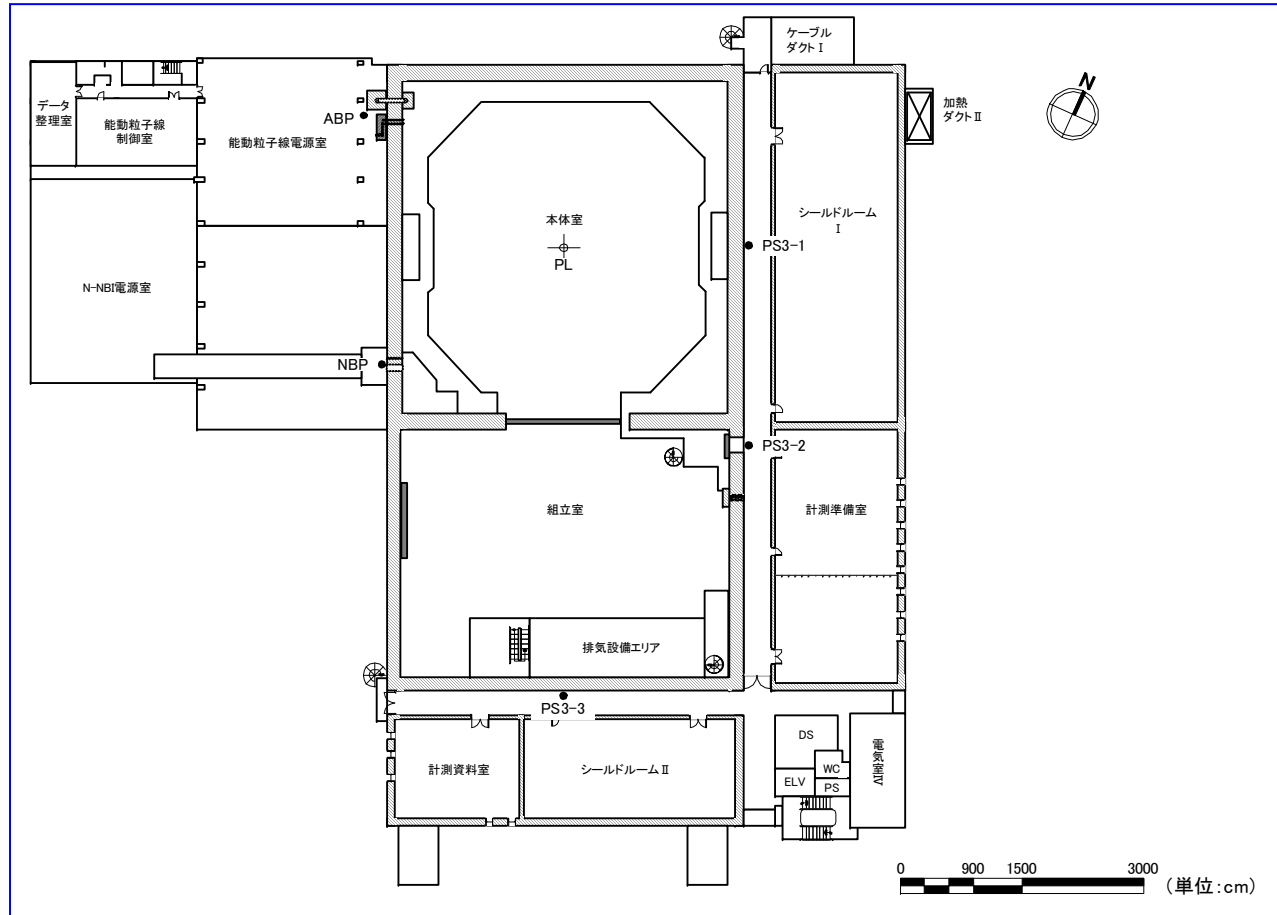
1. 5. 3 JT-60実験棟3階平面図 (単位: cm) (改修前)
